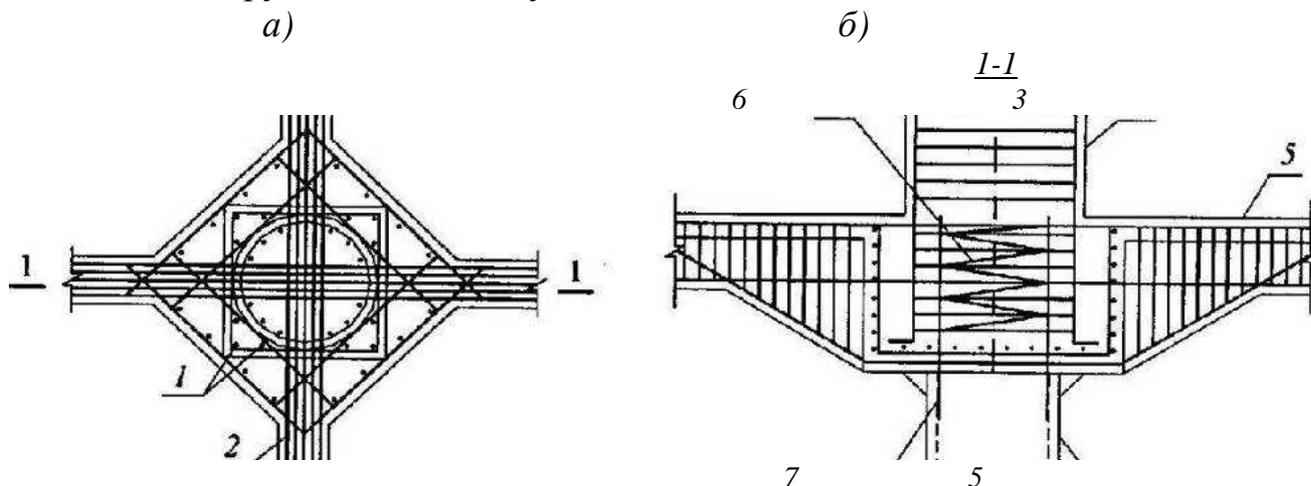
Жесткий узел соединения сталежелезобетонной колонны и стальной внешней обоймы из трубы, расположенной на нижнем этаже и железобетонной колонны, расположенной на верхнем этаже: а – план рас-положения узла стыковки; б – разрез по линии 1-1; 1 – продольная рабочая стержневая арматура верхней железобетонной колонны; 2 – хомутовая арматура; 3 – железобетонная колонна с большим поперечным сечением чем сечение колонны нижнего этажа; 4 – железобетонная балка каркаса; 5 – бетонная колонна со стальной внешней обоймой из трубы; 6 – коротыш из арматурной стали (арматурный каркас приваривается к внутренней стенке стальной обоймы из трубы); 7 – соединительные стержни из арматурной стали
